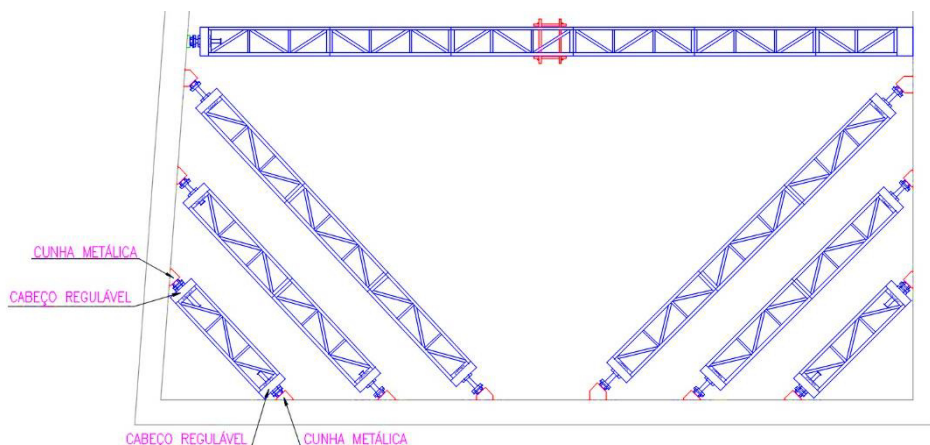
Ilustração tipo do pormenor de ligação à parede.
